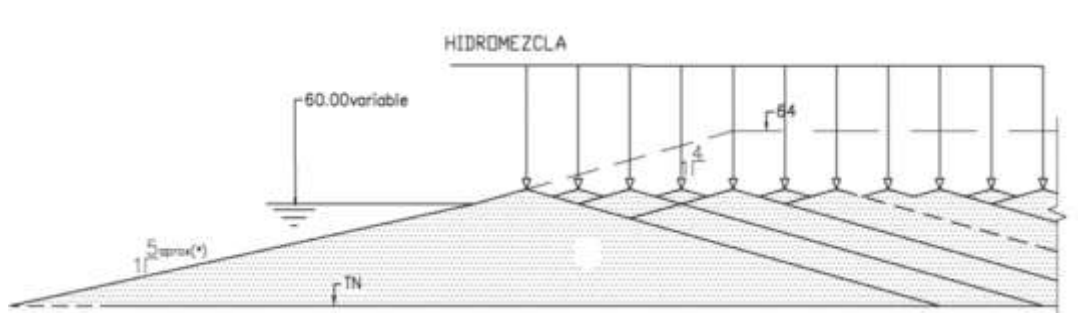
Lanzamiento bajo agua. Esquema de lanzamiento.
